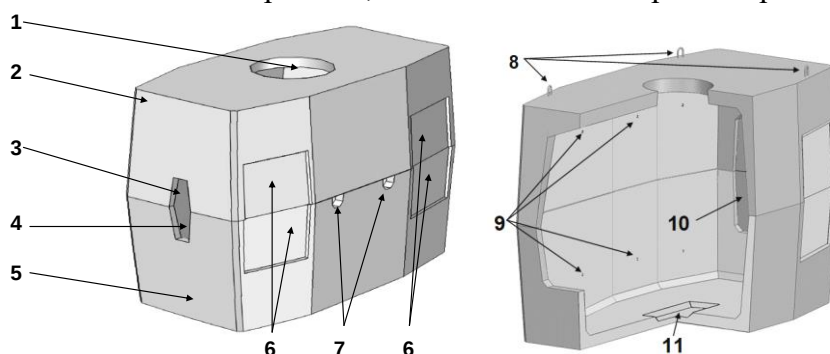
Колодец «ККСр-5-10», внешний вид и детали элементов колодца:
